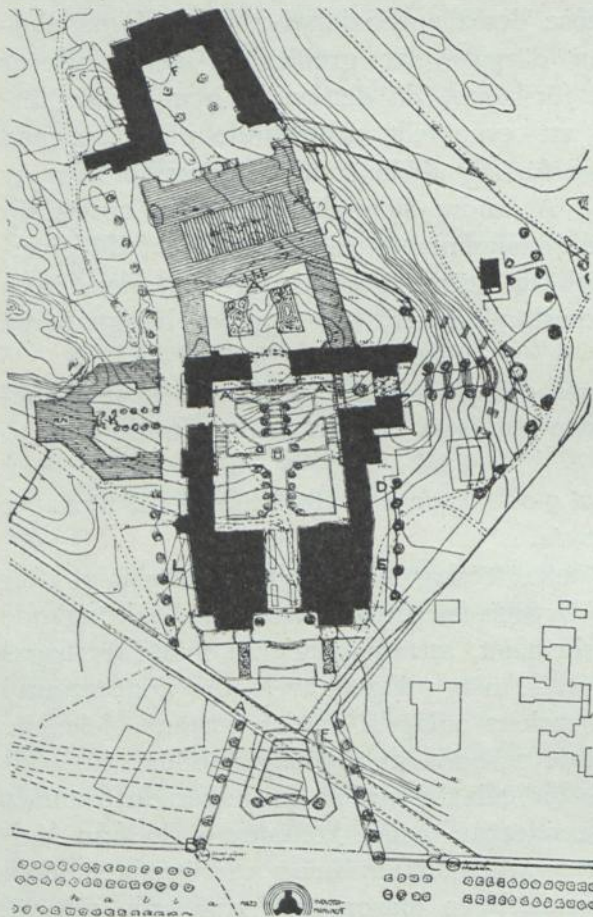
FÖRSTA PRIS: SITUATIONSPLAN.
